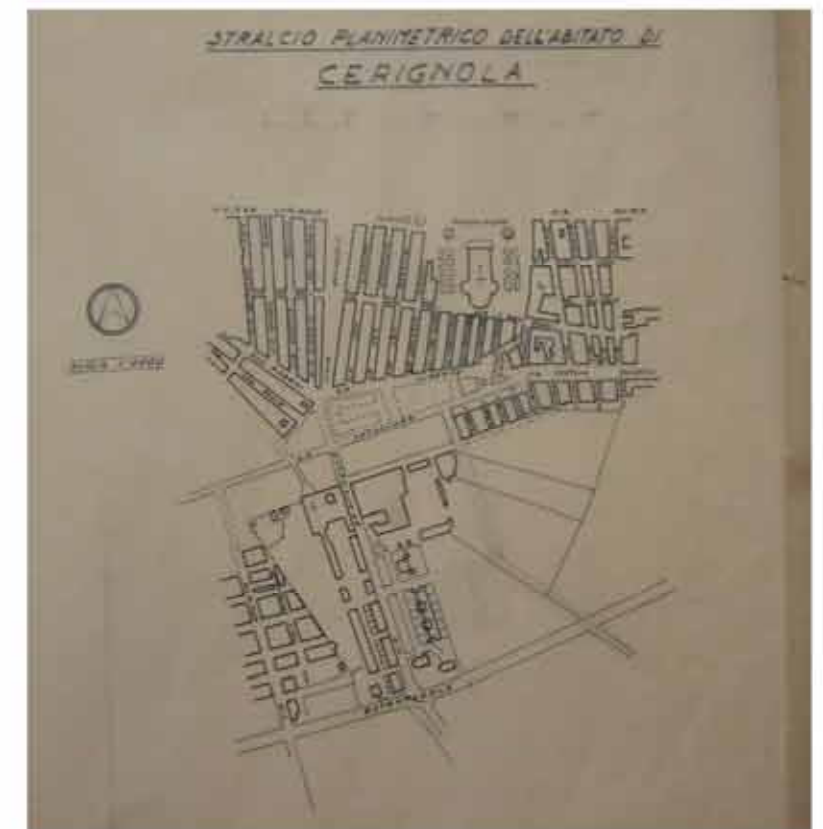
dettaglio del disegno della planimetria generale dove è individuato il quartiere rispetto al centro della città di Cerignola
